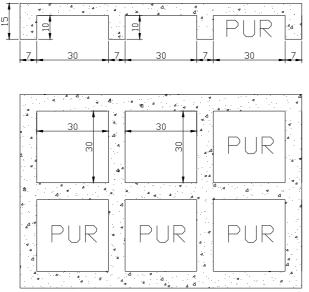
Detalhamento padrão das lajes nervuradas utilizadas.
